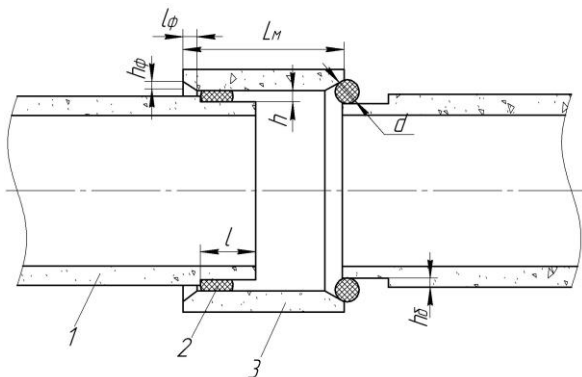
Монтаж асбестоцементного трубопровода:
